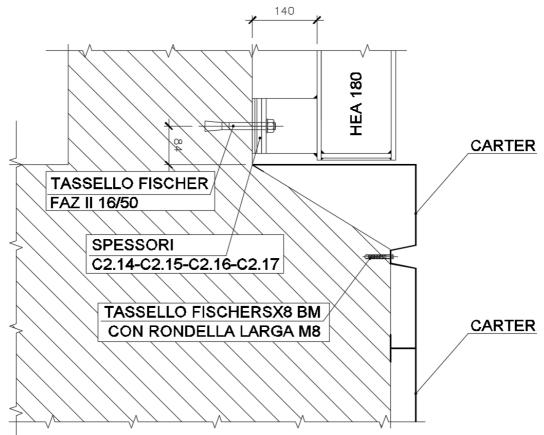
Dettaglio del collegamento inferiore HEA180 alto barriera testata galleria
